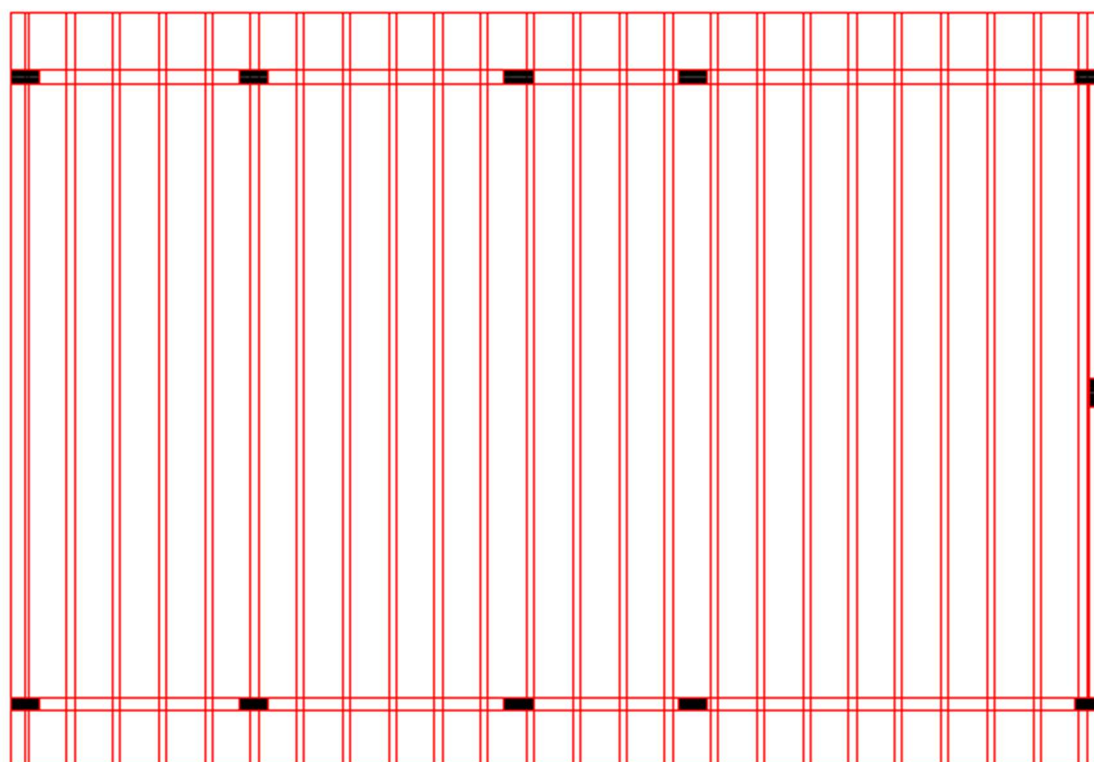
Seção das vigas de respaldo e detalhes da armadura long/trans.
